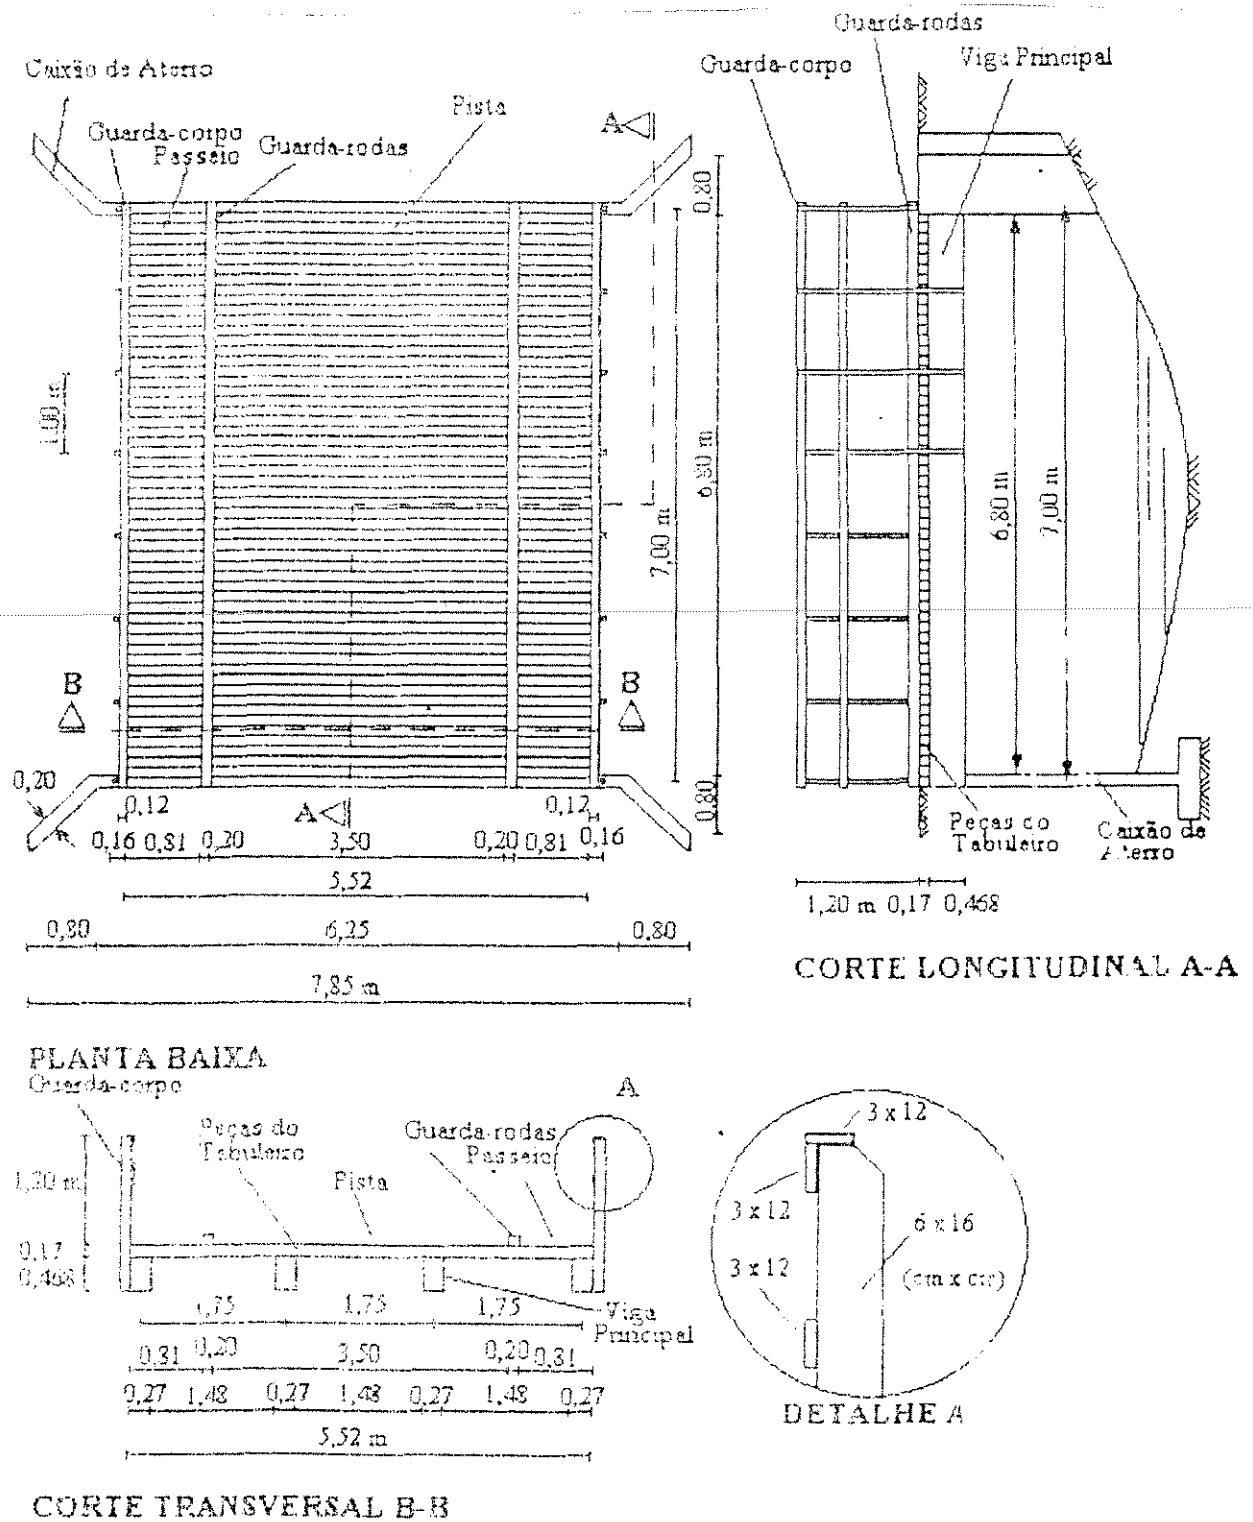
Dimensões finais da ponte em estudo. (Fonte: LOGSDON, 1996)
